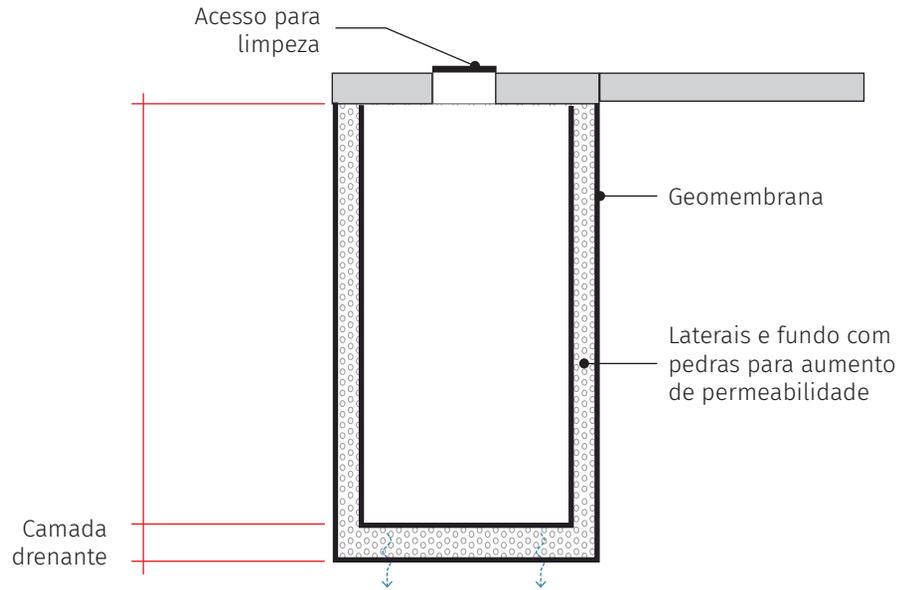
Corte esquemático de facilitador de infiltração do tipo poço (FCTH, 2024)
